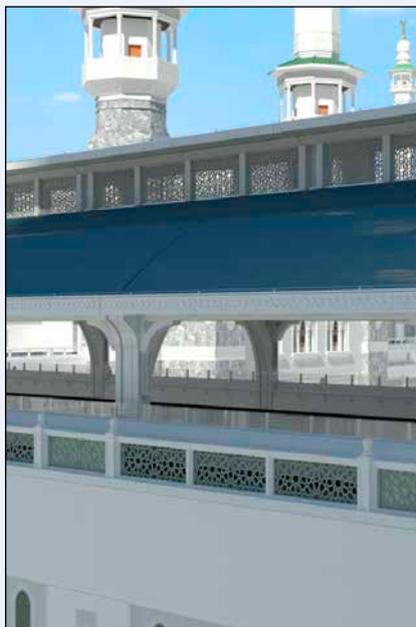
Ausschnitt der Brückenkonstruktion mit eFORM color „Mecca Green“
